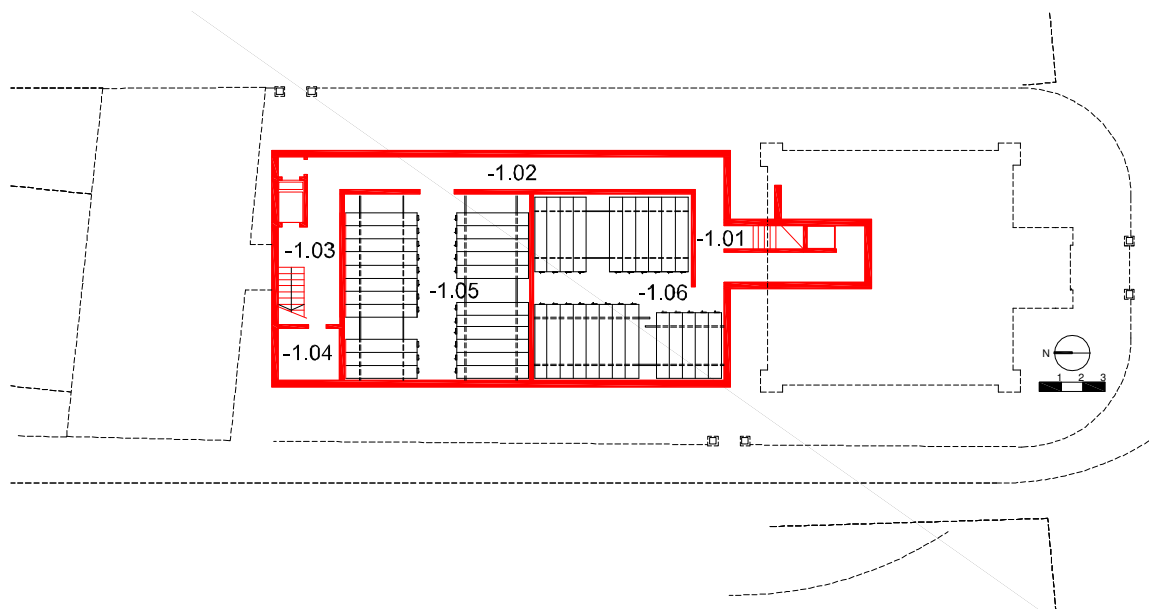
Planta da Nova edificação com as Cores Convencionais
